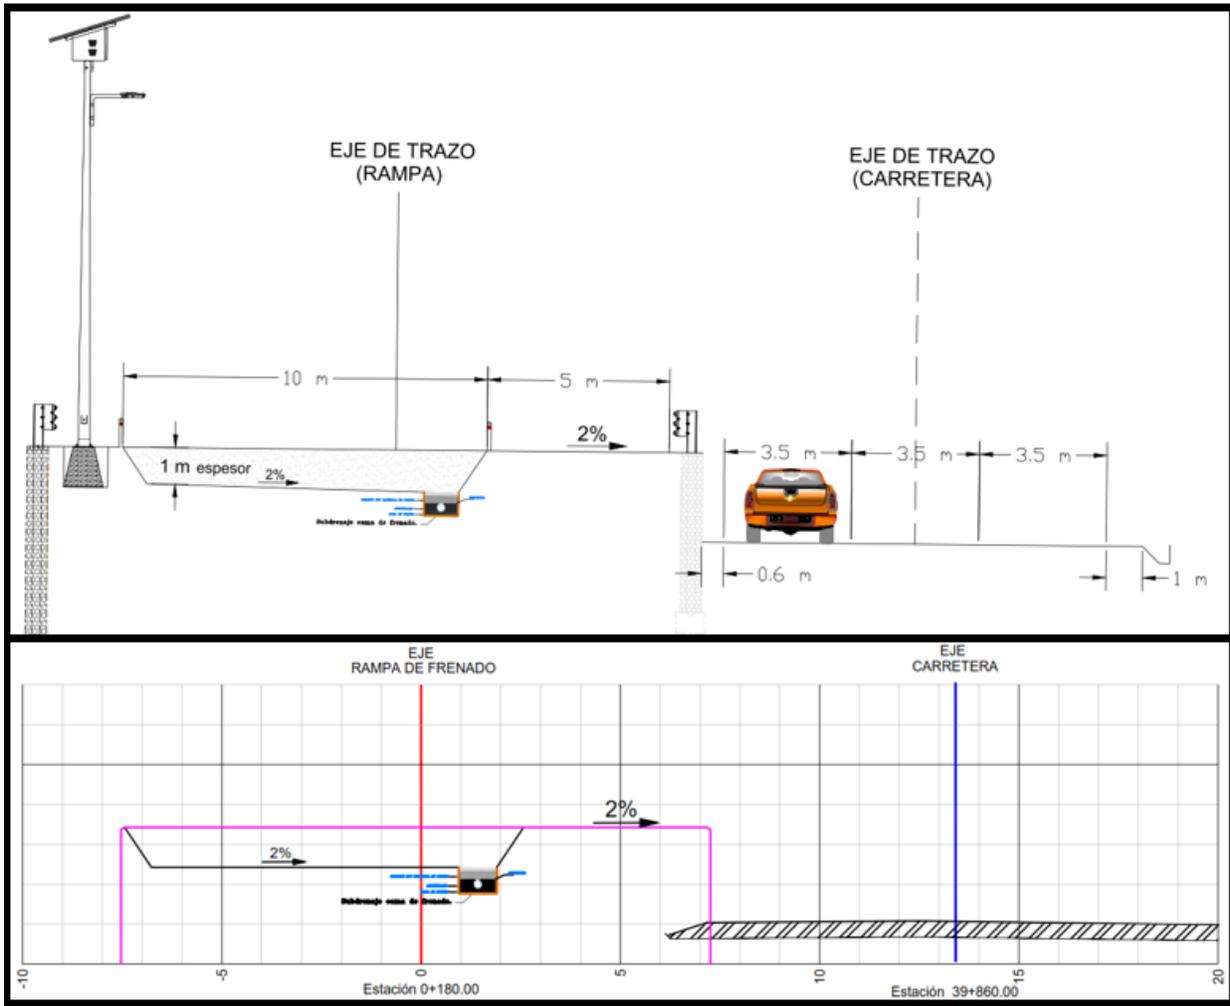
Sección transversal esperada (arriba) y sección transversal indicando un volumen para construcción de cama de frenado y camino de servicio (abajo).
